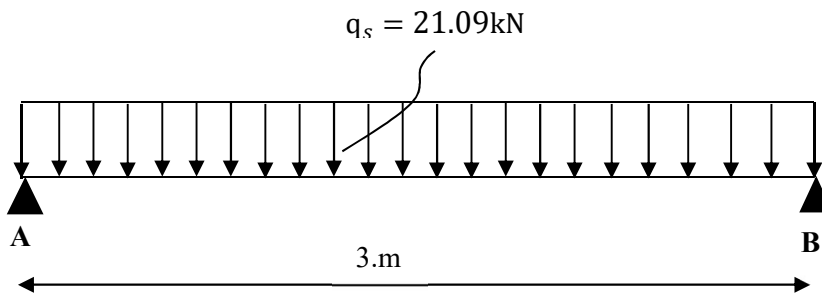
Schéma statique de la poutre palière a l'ELS.
